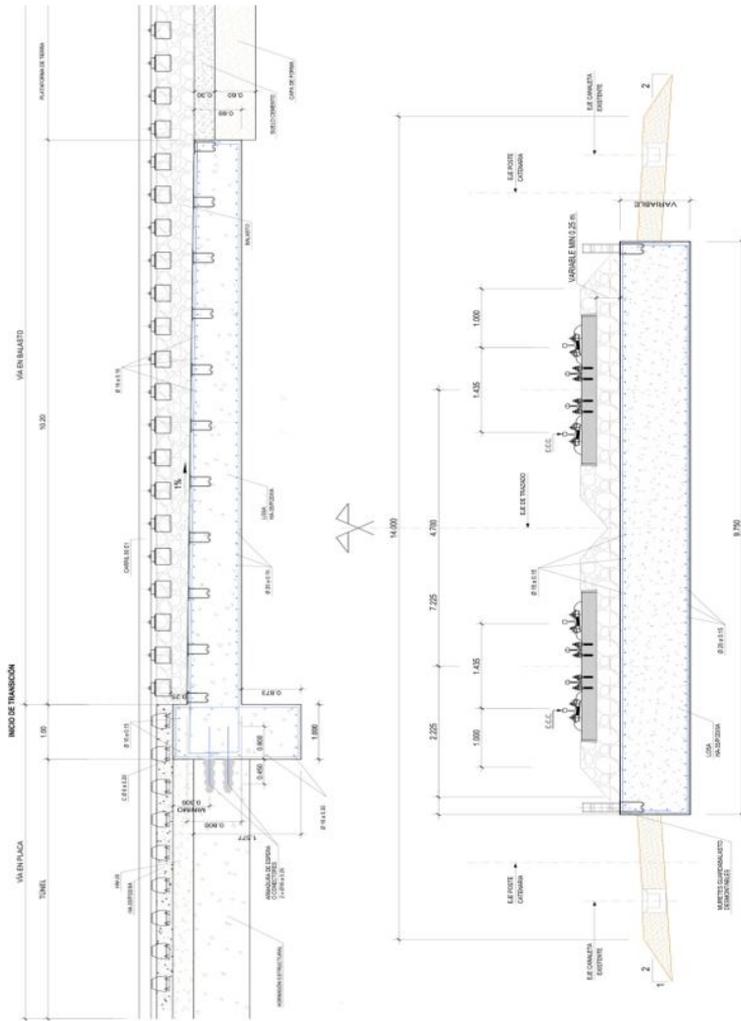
Detalle de la zona de transición prevista por ADIF. Secciones longitudinal y transversal de la losa, (FUENTE: Instrucción general para la redacción de proyectos de vía IGV-2011 [10]. IGV-1.15 Interacción vía-estructura)
